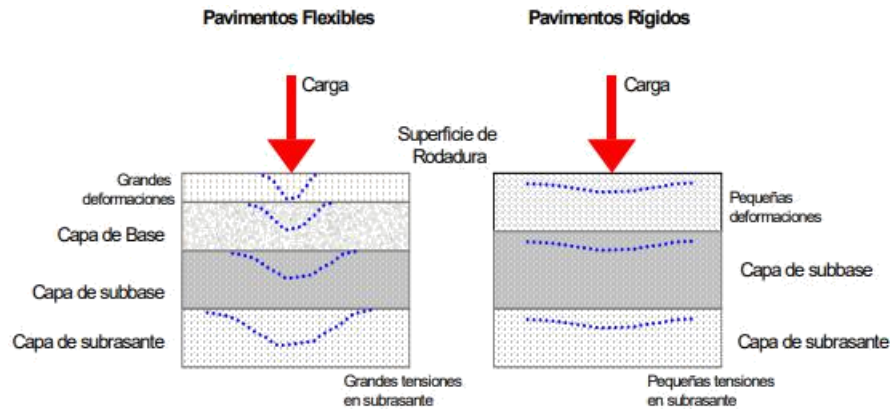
Comportamiento de pavimentos flexibles y rígidos
